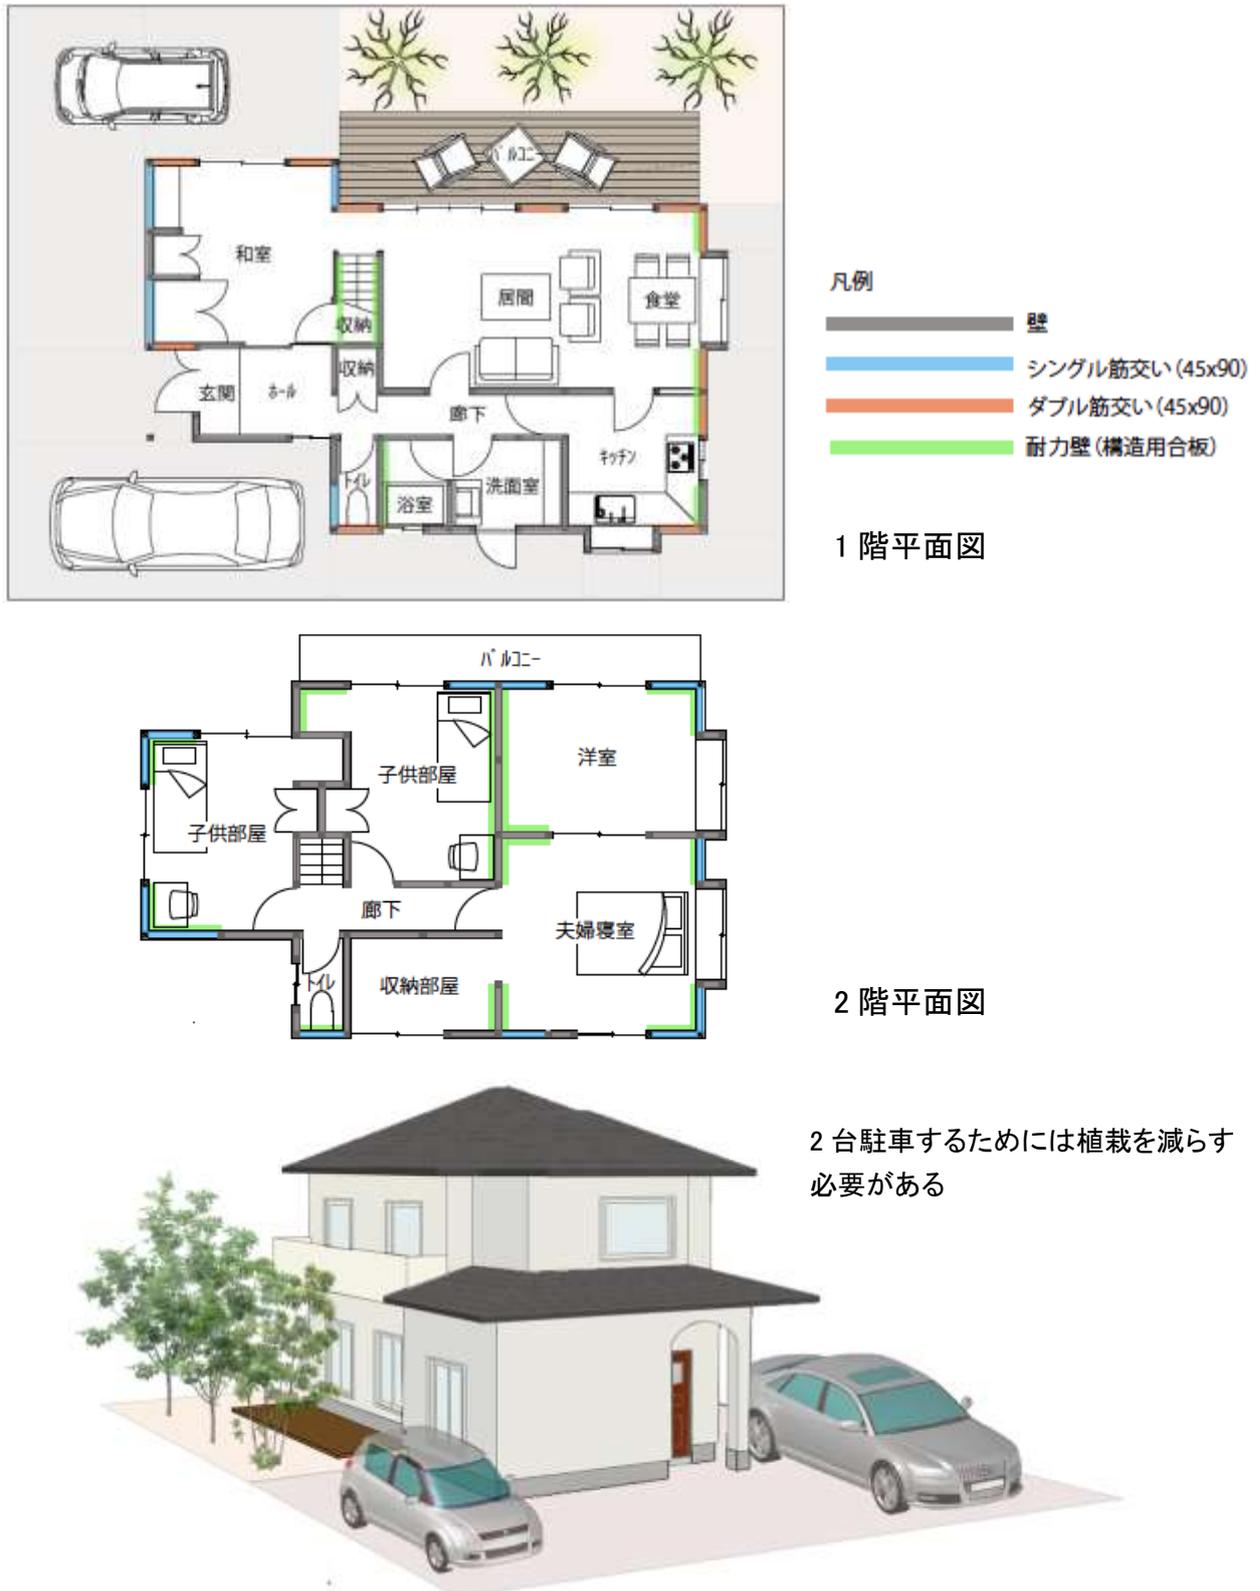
既存住宅の1階平面図(上)、2階平面図(中)、外観パース図(下)
